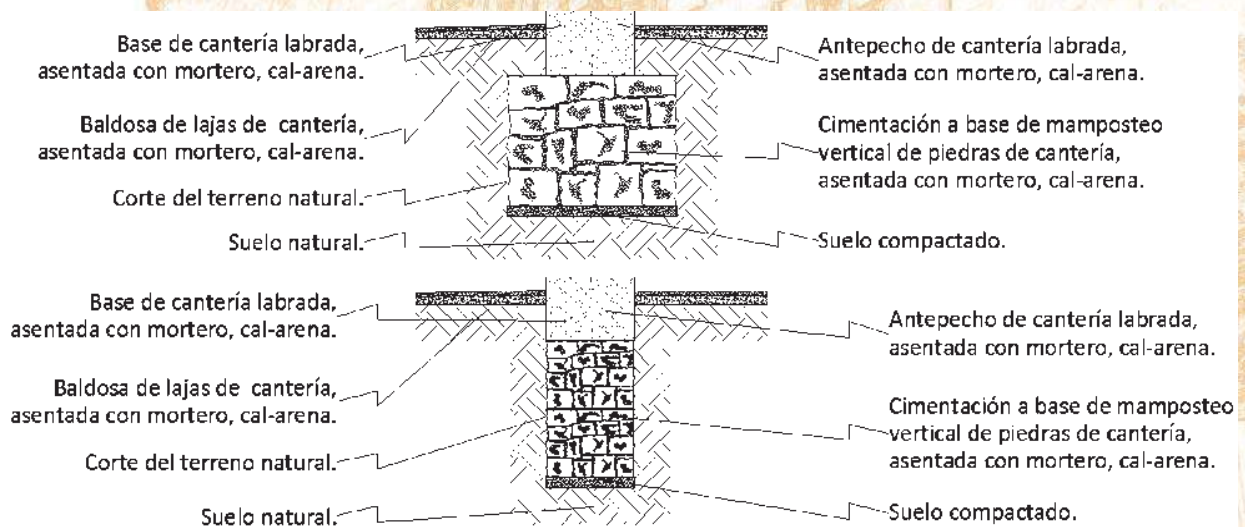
se muestra la colocación de la piedra que compone la cimentación y los materiales de construcción. Figura: E. L. Torres, P. C.
